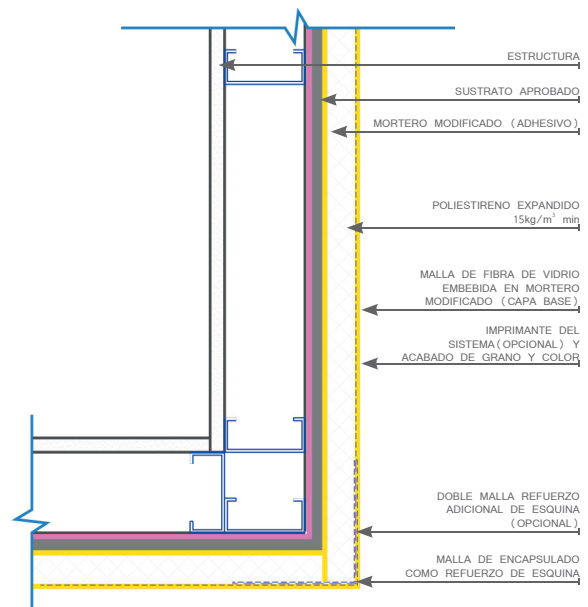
k: Detalle constructivo de refuerzo de esquina en EIFS, (vista corte horizontal).
